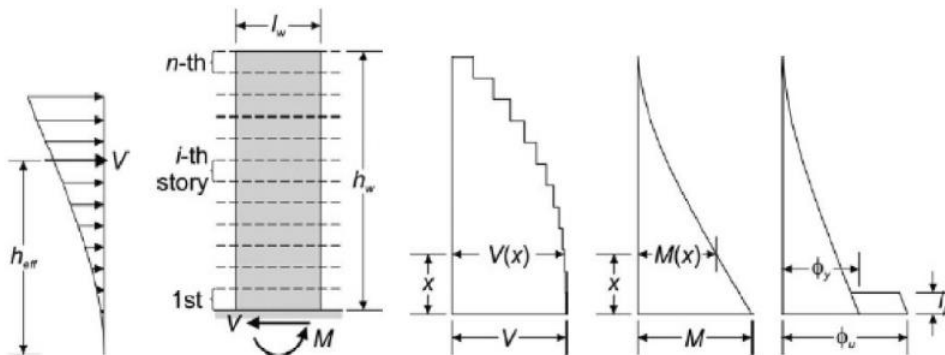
Capacidad de los muros estructurales (Cortante - Desplazamiento)
